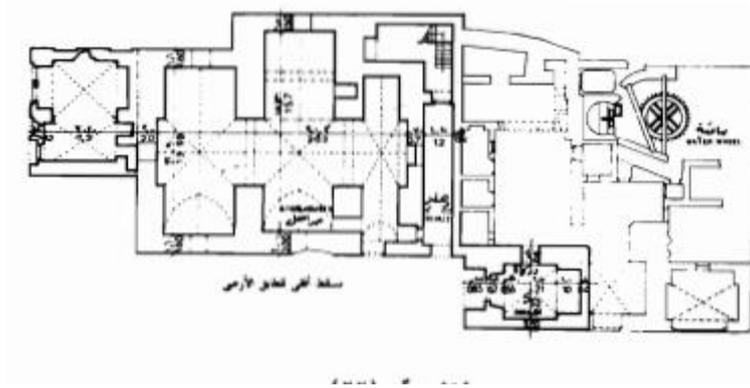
مسقط أفقي للطابق الأرضي بمنزل الكريدلية وآمنة بنت سالم (من كتاب خالد عزب)
